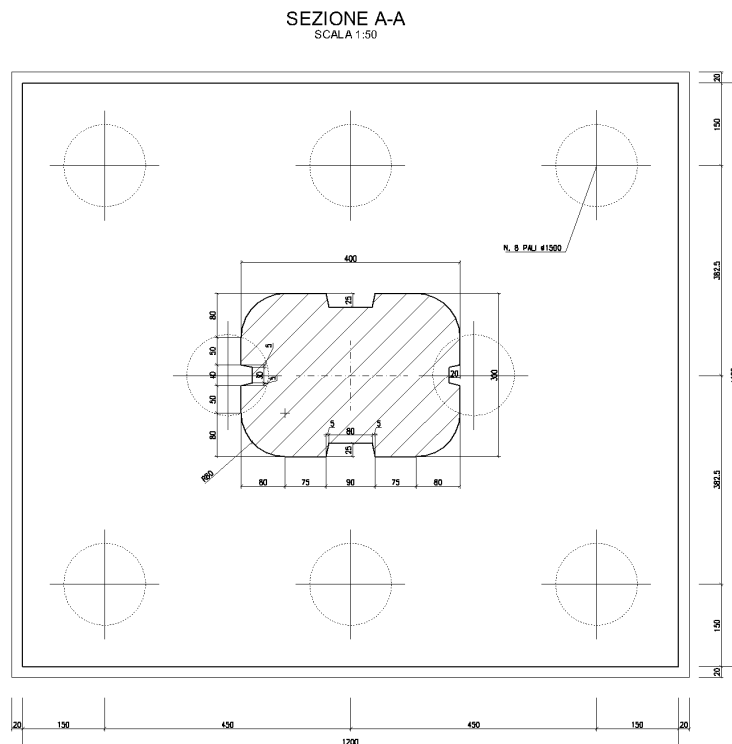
Pianta del plinto di fondazione tipo B.
